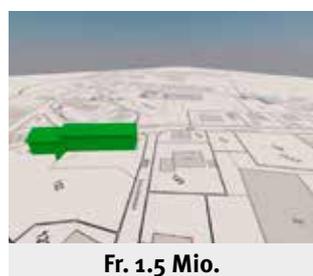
Situationsplan Sproochbrugg, Neubau 5./6. Klassen
